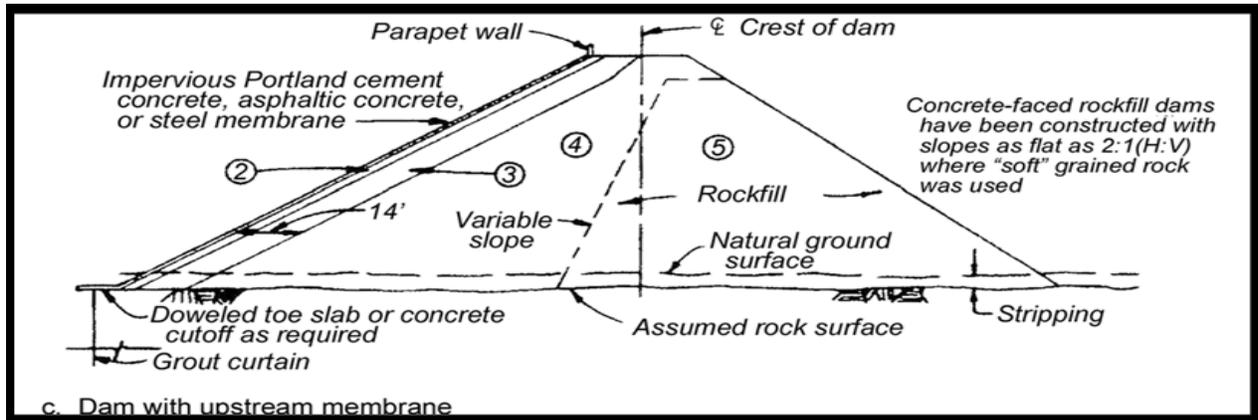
coupe d'un barrage en enrochement avec masque amont (USBR, 1977)
